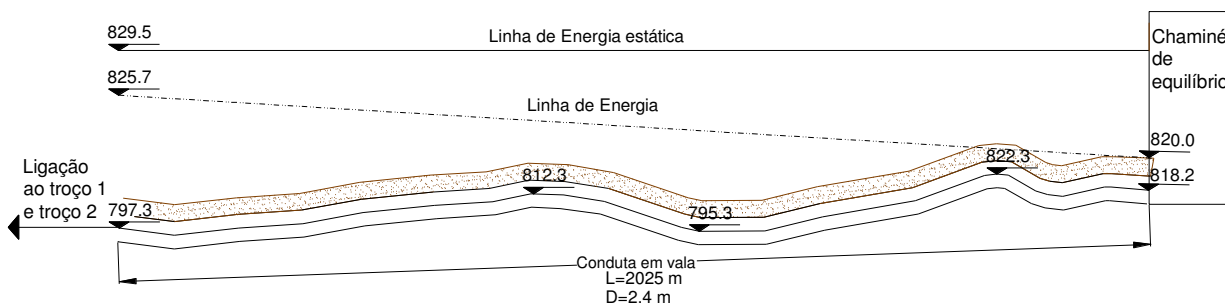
Perfil esquemático do trecho 3 da conduta (D=2.4 m) – solução 2.
